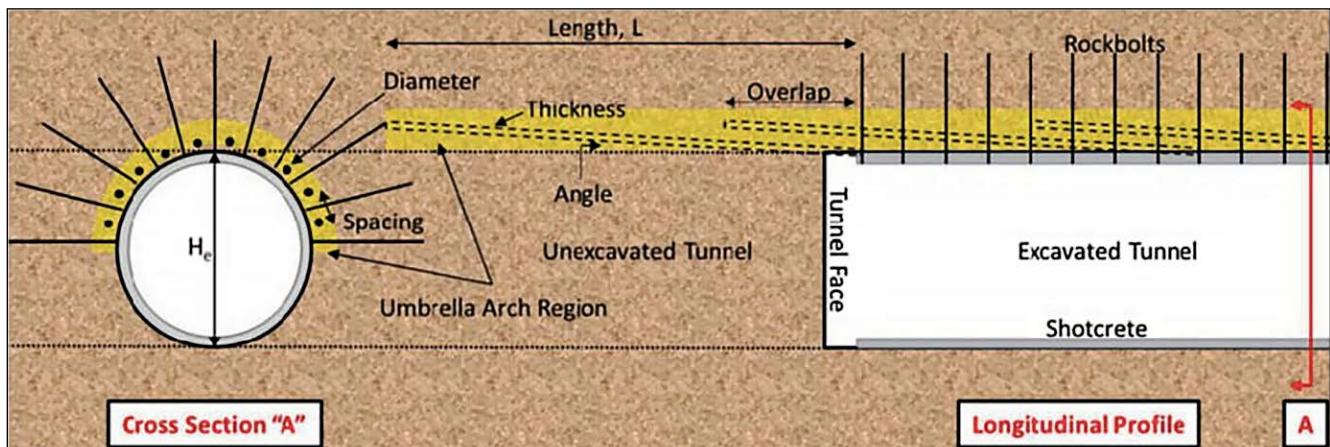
Схема создания «зонта» опережающей крепи перед забоем туннеля.
